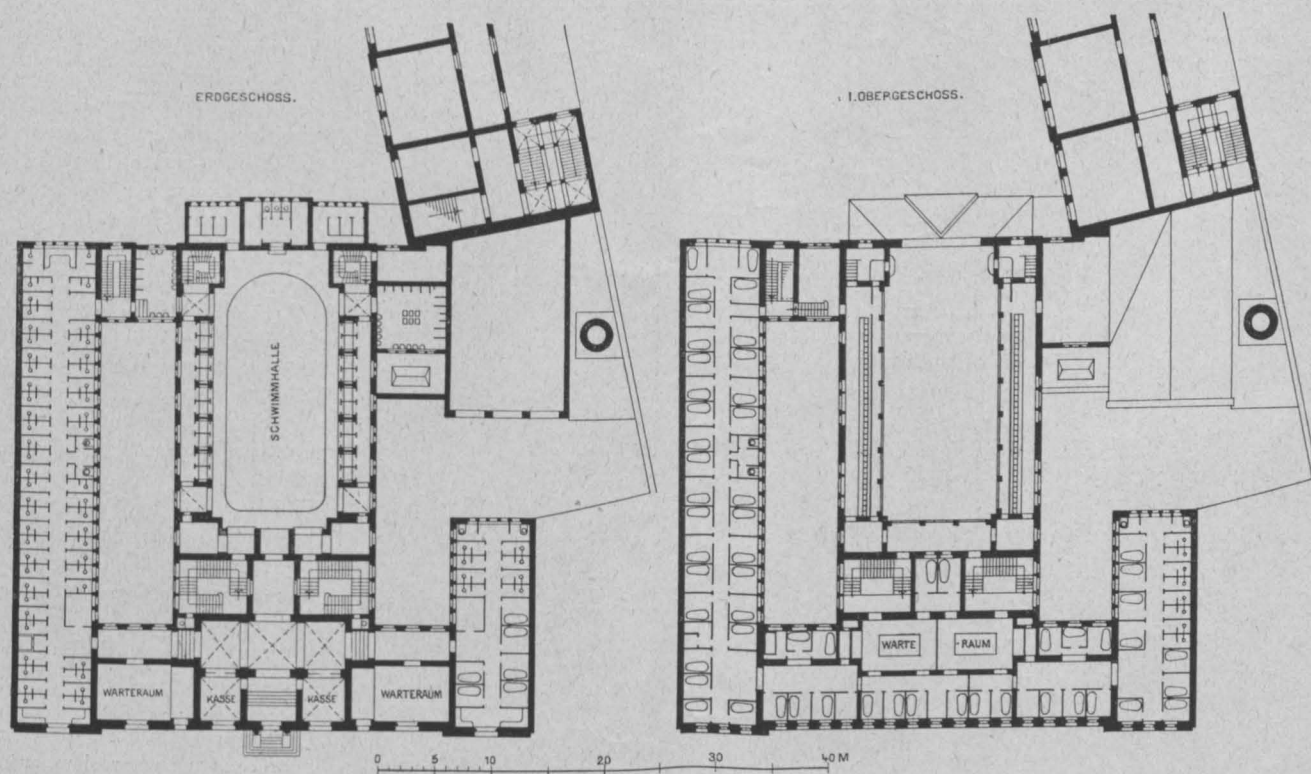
Grundrisse der Badeanstalt, Bärwaldstraße.
